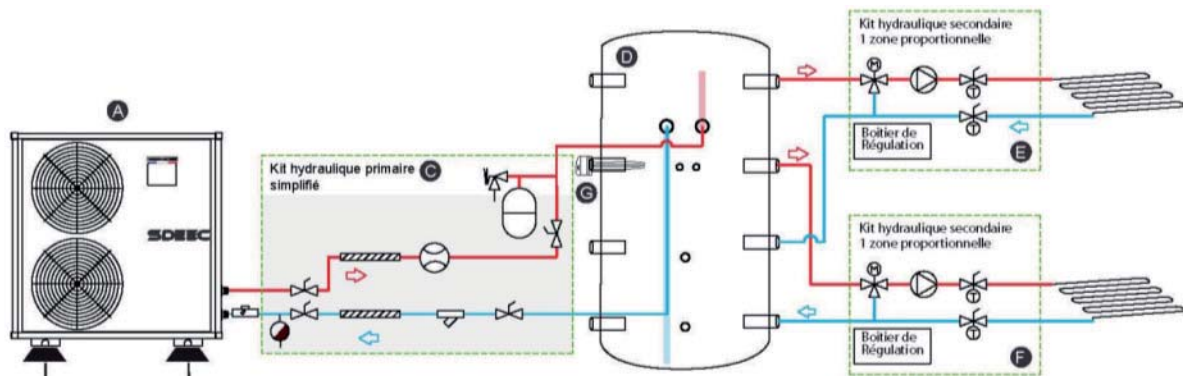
Schéma hydraulique BTR sur planchers ou ventilo-convecteurs
